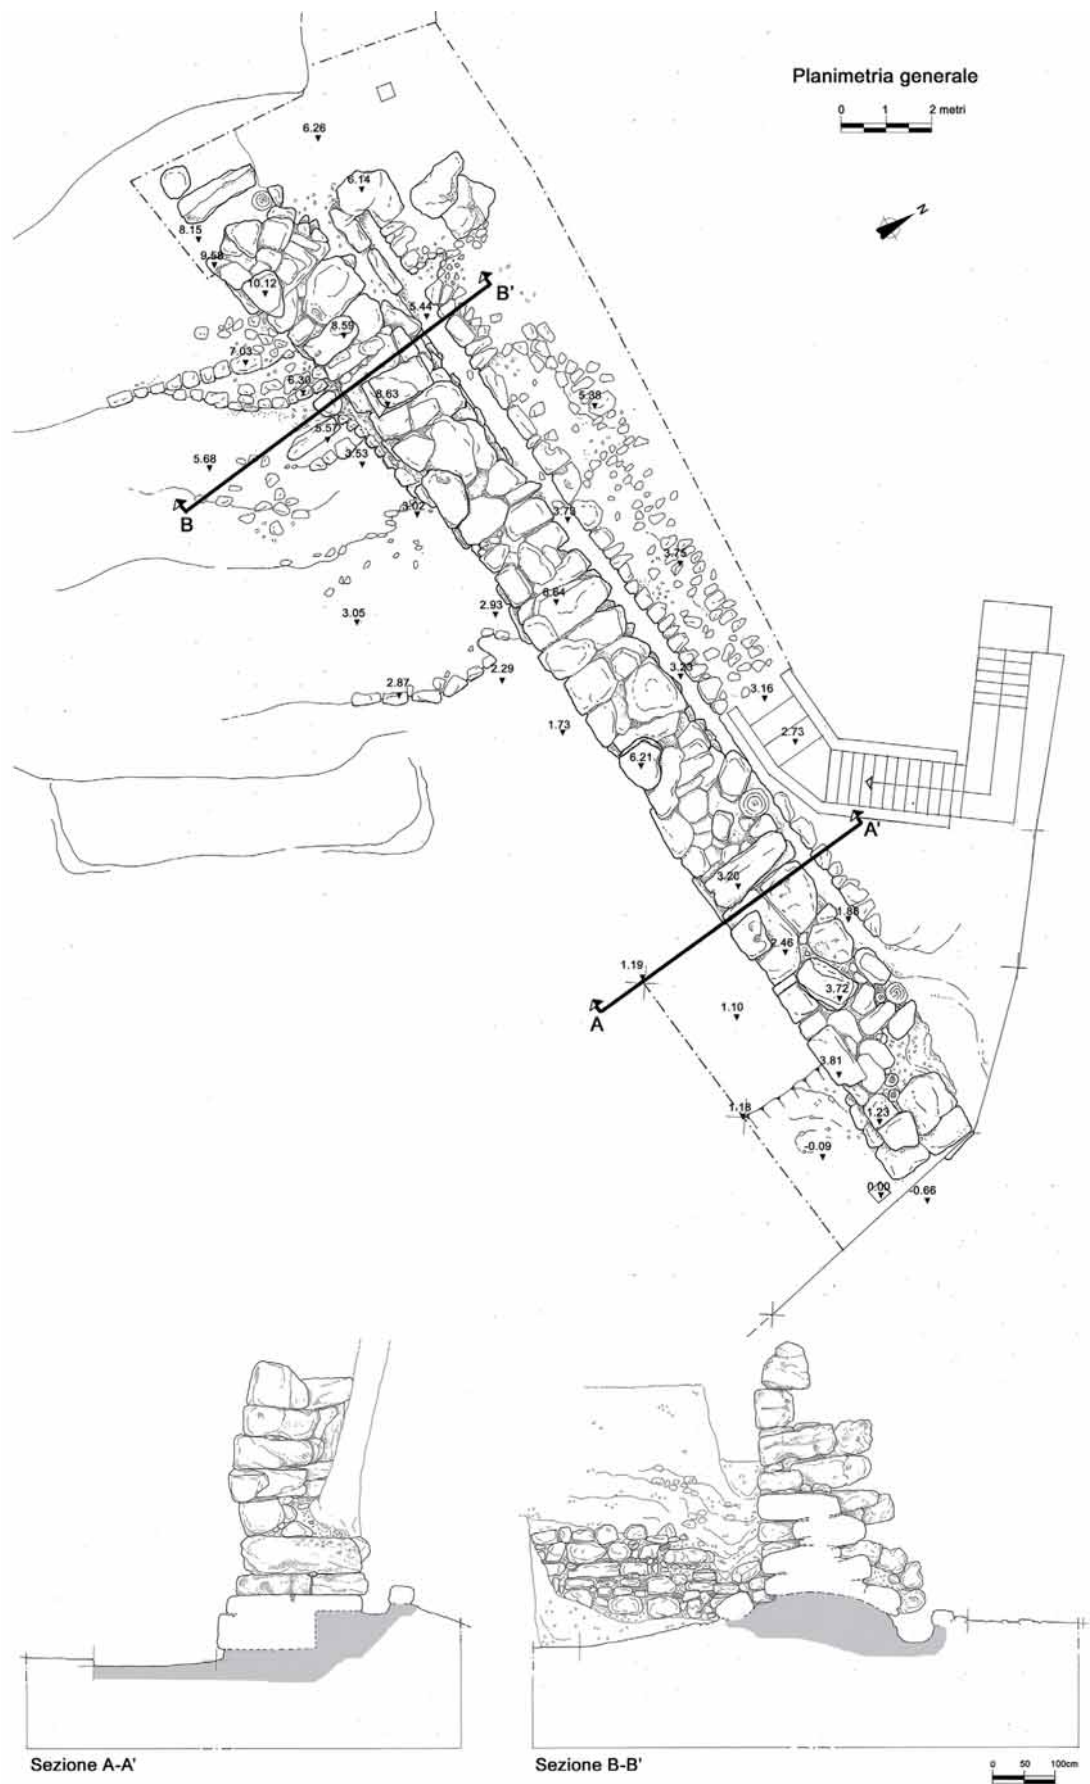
Muro località Sant'Andrea. pianta e sezioni. (M.R. Galanti e R. Sabelli)
